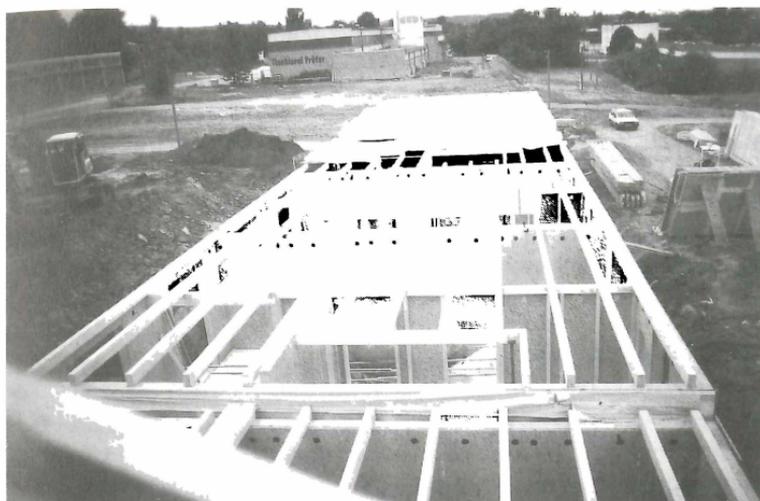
Auswechslung mit deckengleichem Unterzug in der Deckenbalkenlage
